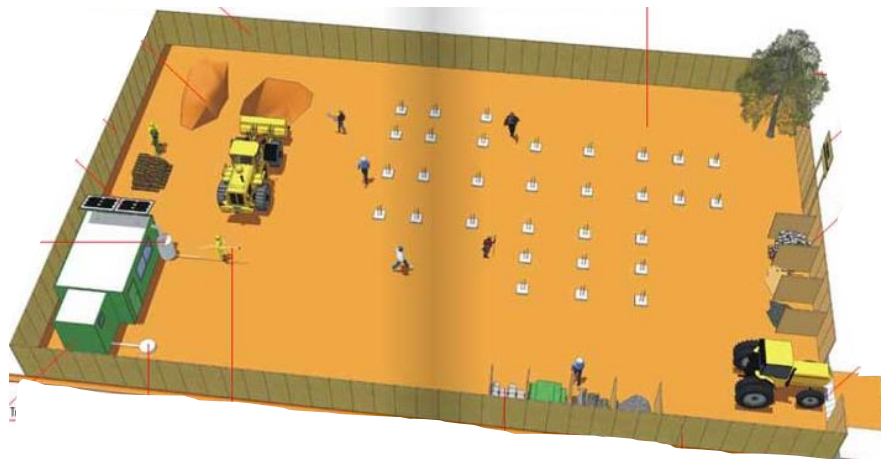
Canteiro Restrito – Empreendimento Residencial vertical
